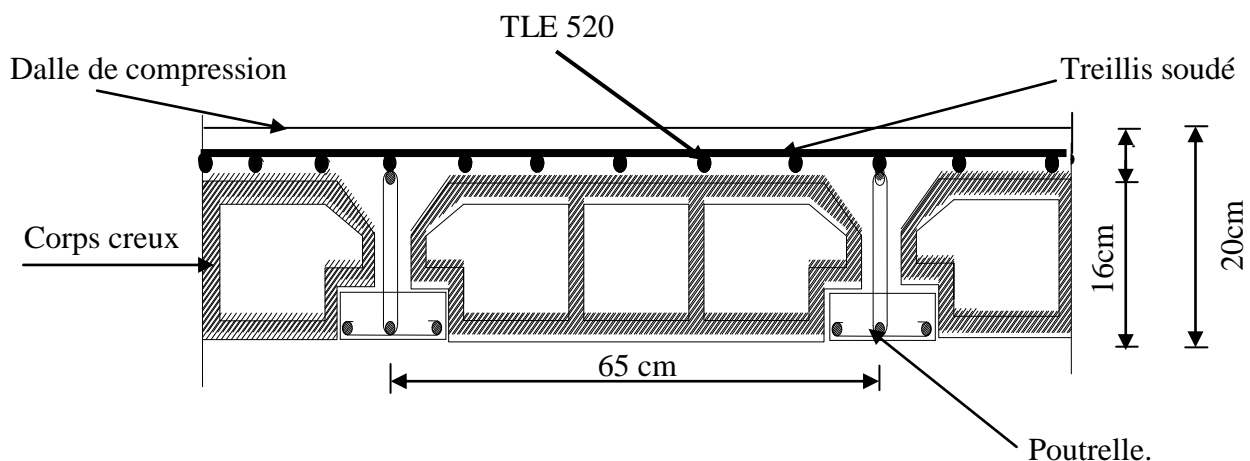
coupe verticale d'un plancher en corps creux
